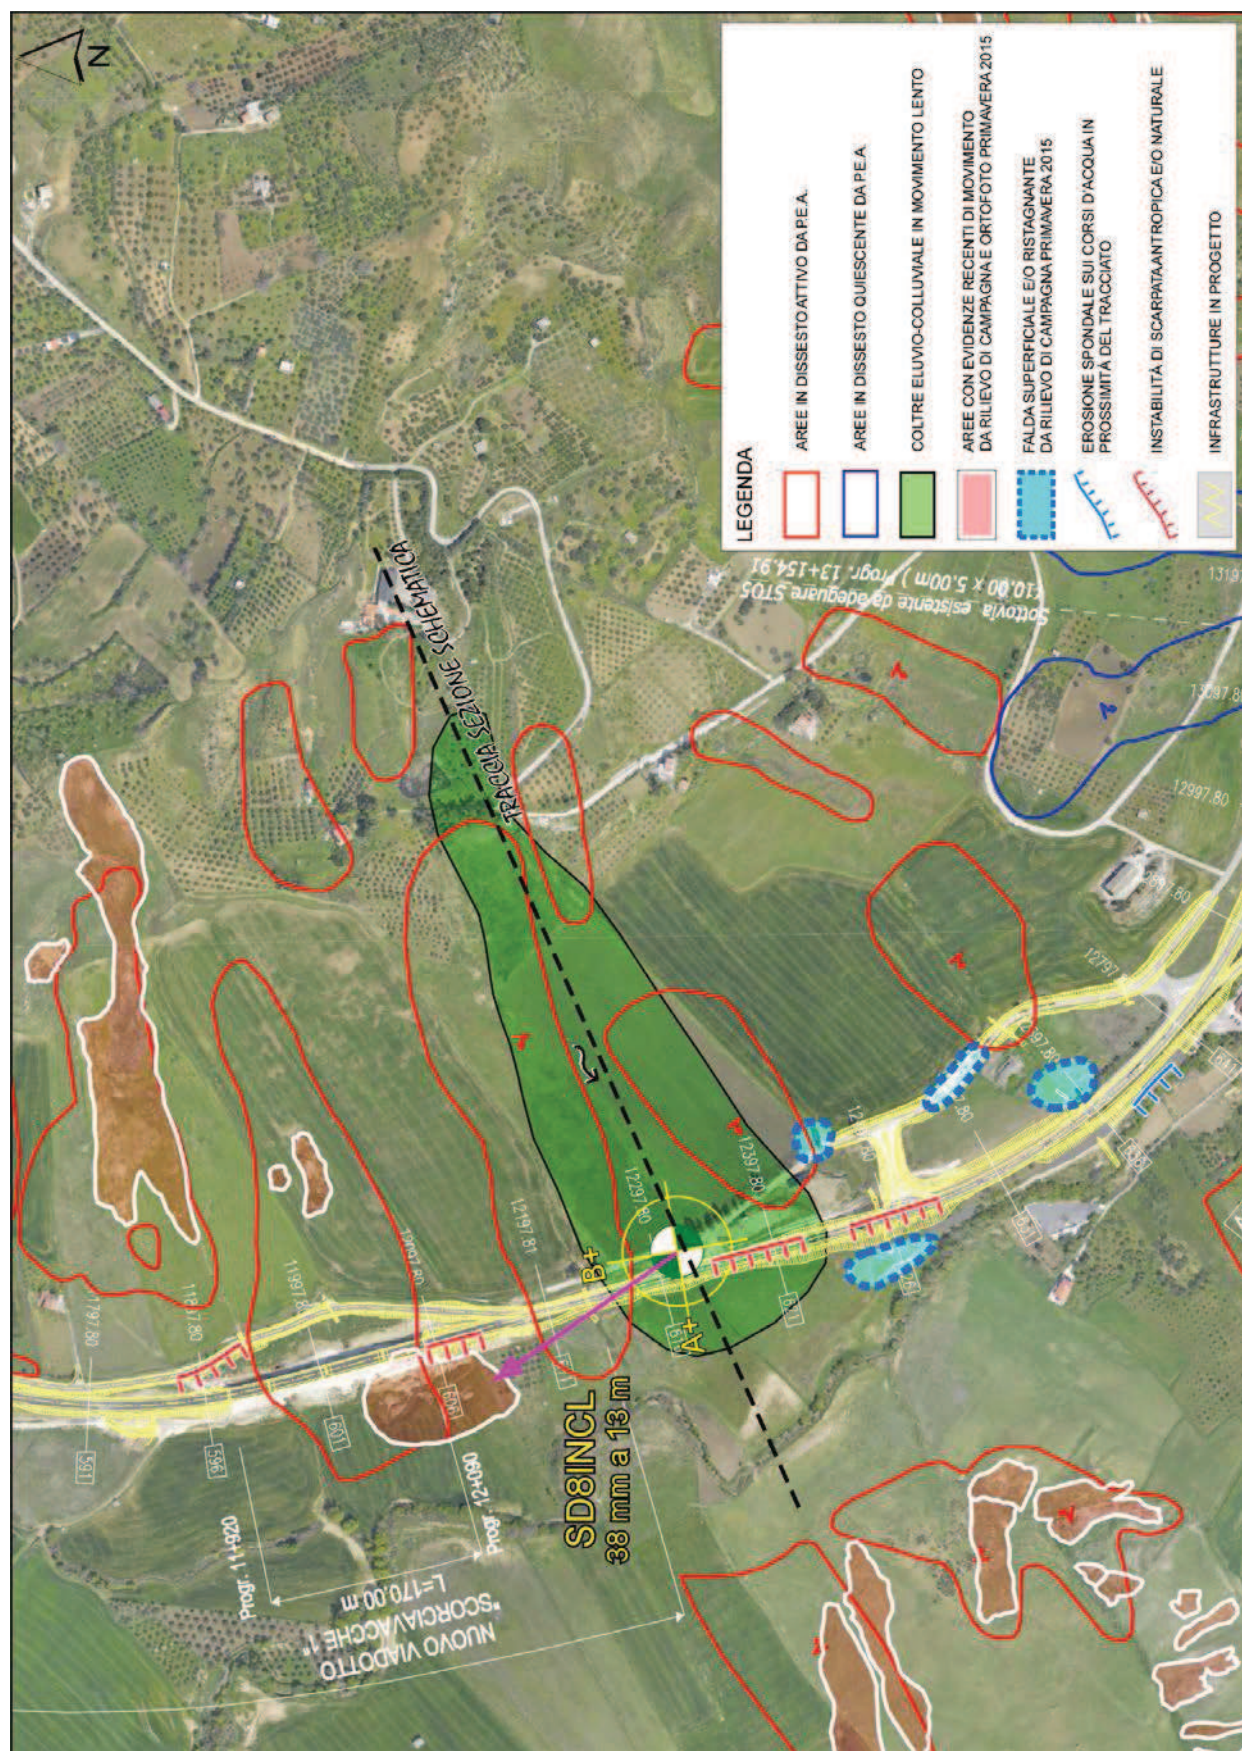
PK 12+657, SVINCOLO MEZZOJUSO. Individuazione planimetria dell'area in movimento
